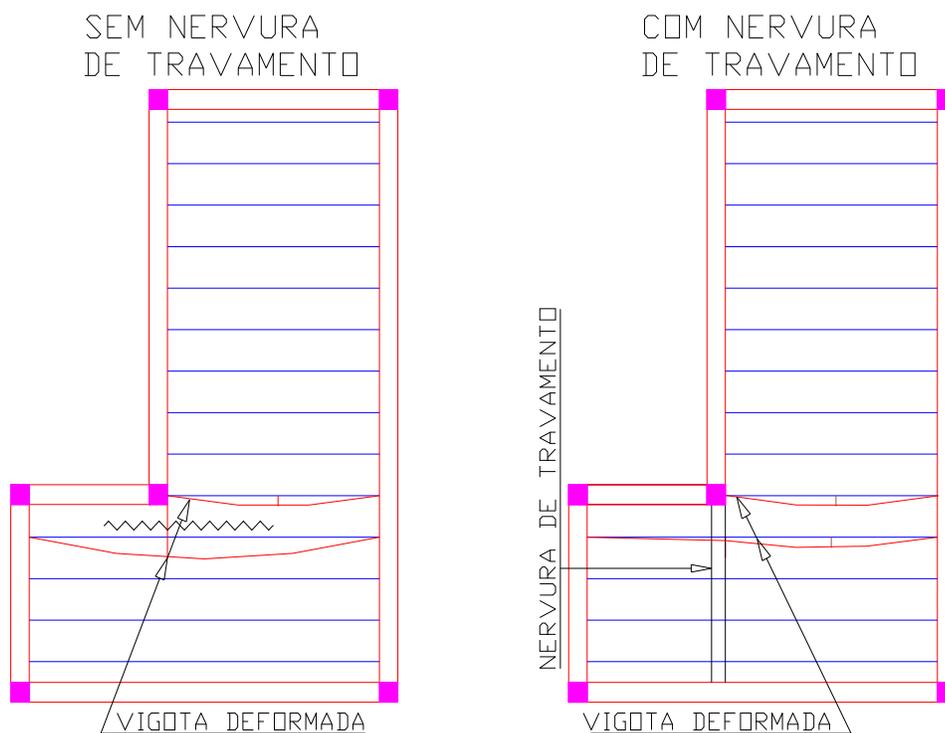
Patologia por falta de nervura de travamento (Surgimento de fissura no revestimento do teto, na interface da vigota com elemento de enchimento). Fonte: arquivo do autor
